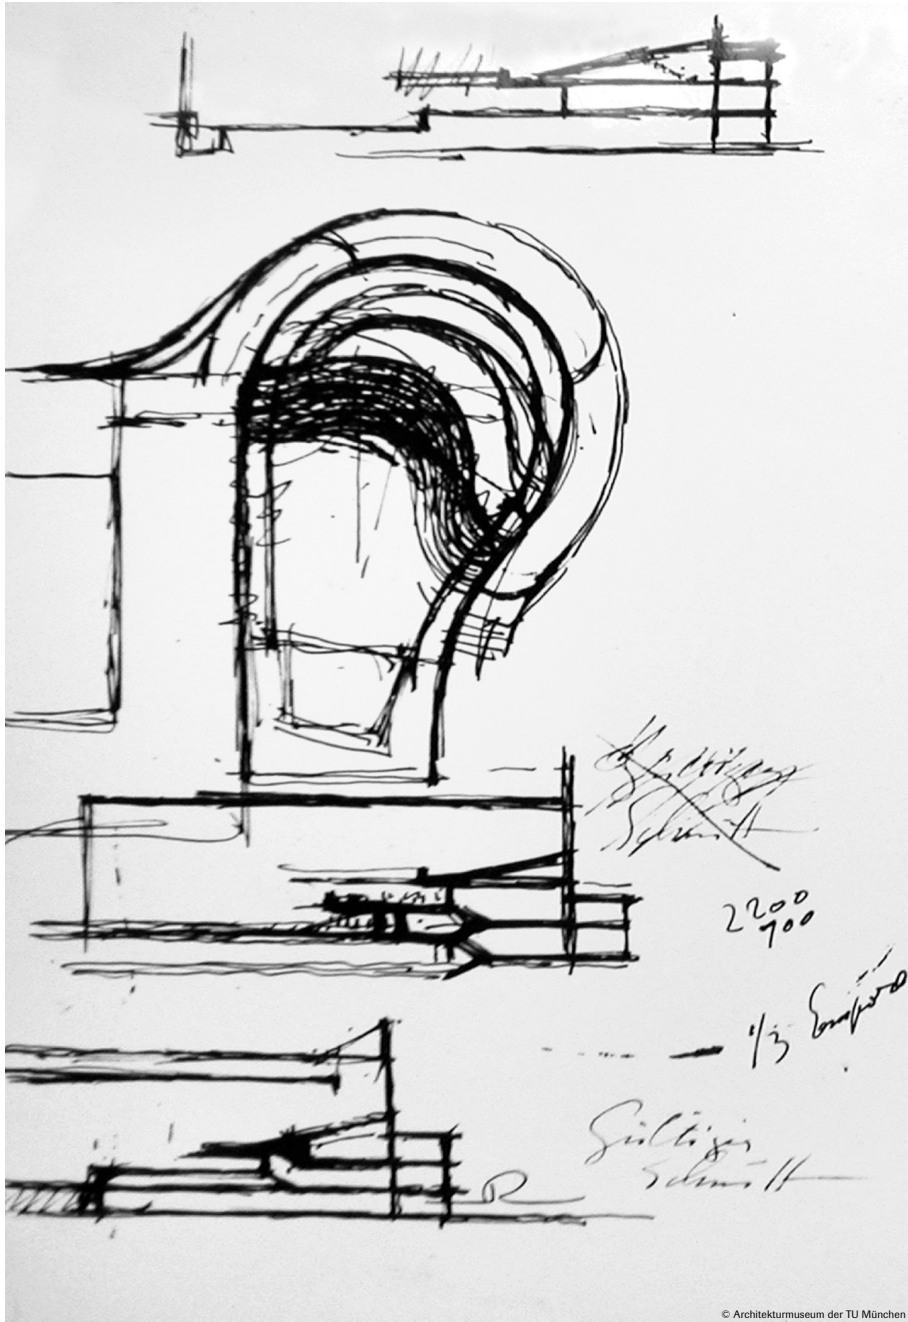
Grundriss- und Schnittskizzen: Adolf Abel, 1953.
